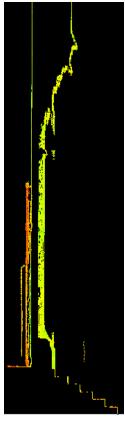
PLANO SECCIÓN en alzado. Fuente propia.
